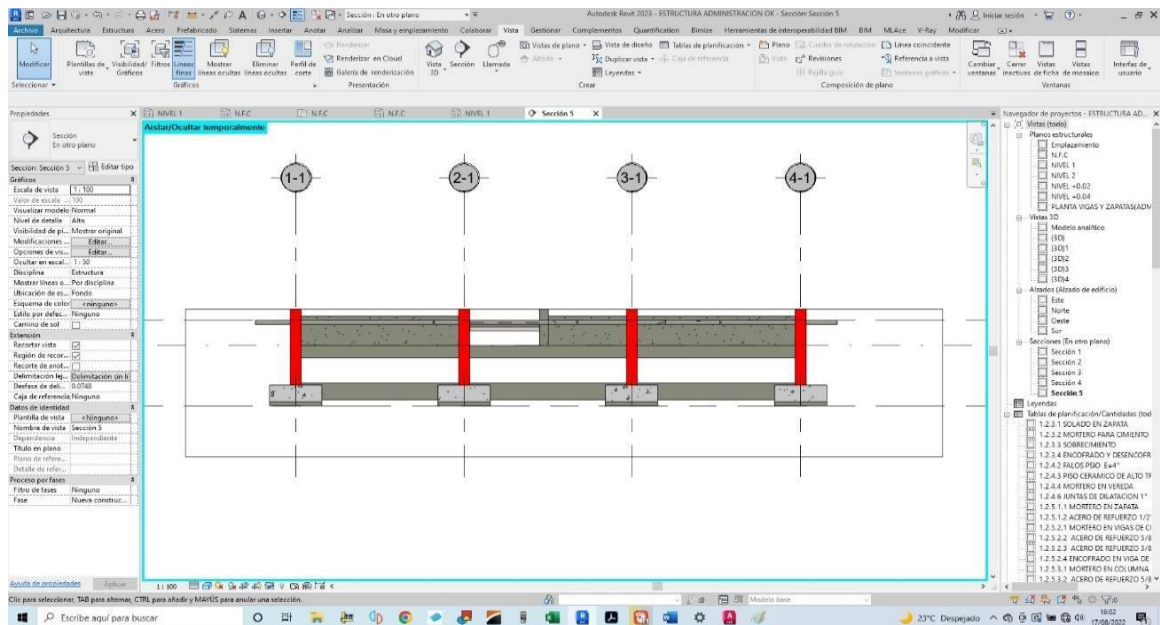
Elevación frontal, vista de zapatas conectadas, vigas de cimentación y sobrecimiento armado.
